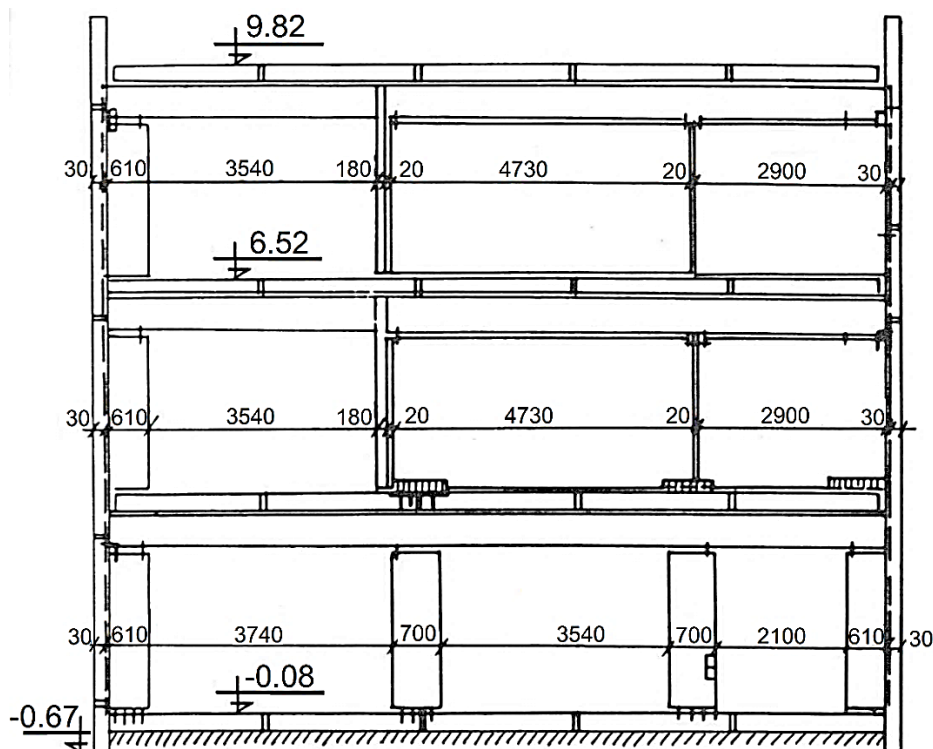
Реальная схема поперечной несущей стены типового каркасно-панельного здания серии 75
